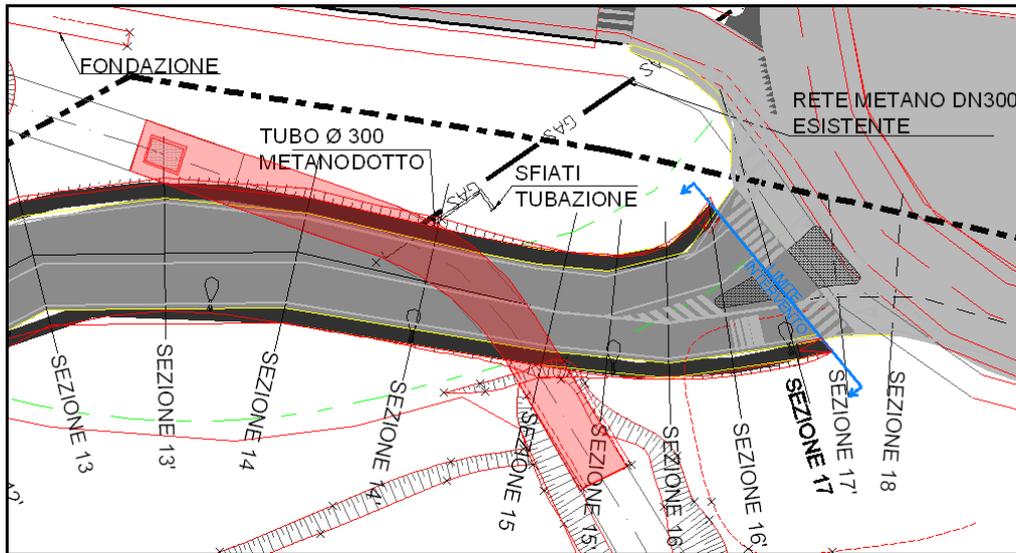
Stralcio planimetrico con l'individuazione del collettore idraulico Roncallo.
